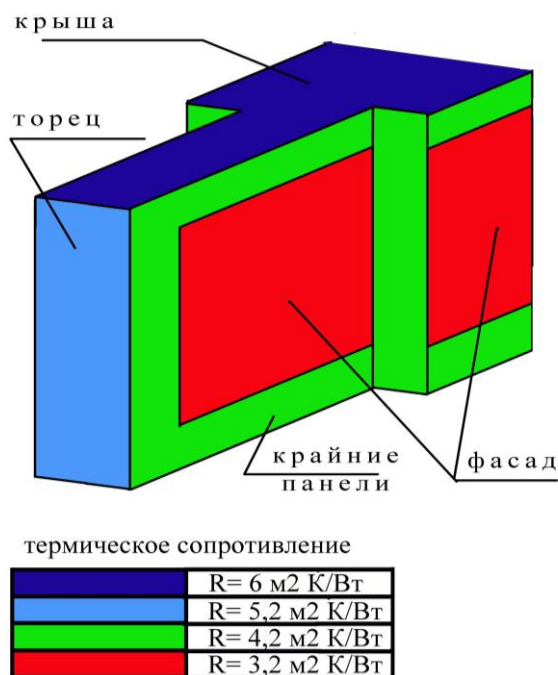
Уровень теплопотерь по фасаду многоэтажного жилого дома
